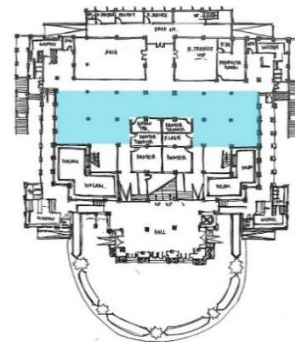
Denah Eksisting Masjid Al-Aqsha Klaten Lantai 2
